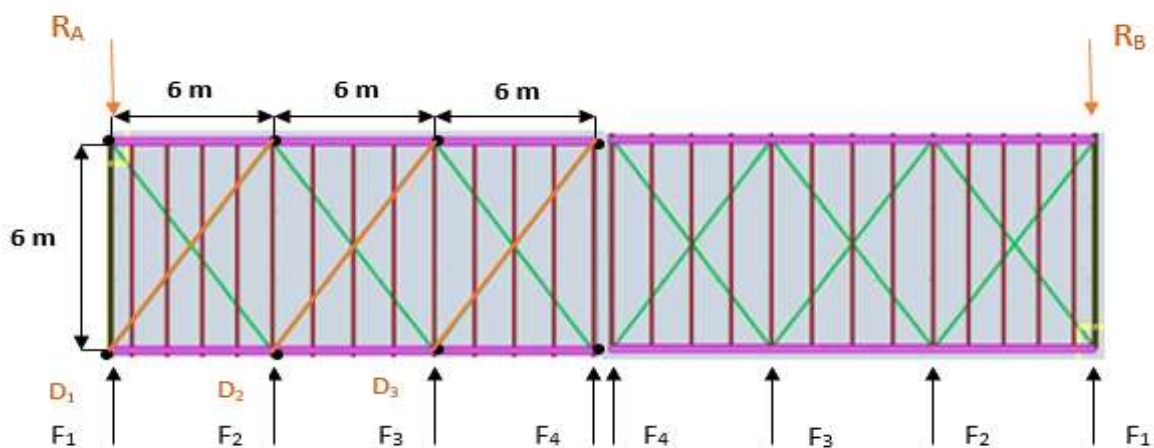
Disposition des efforts sur la poutre au vent.
